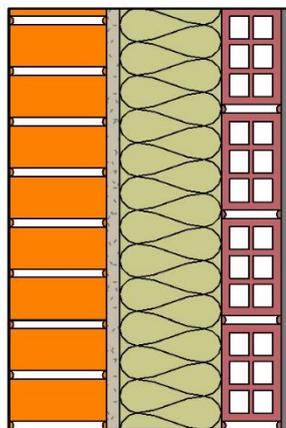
Detalle cerramiento exterior. Fuente: [2]
